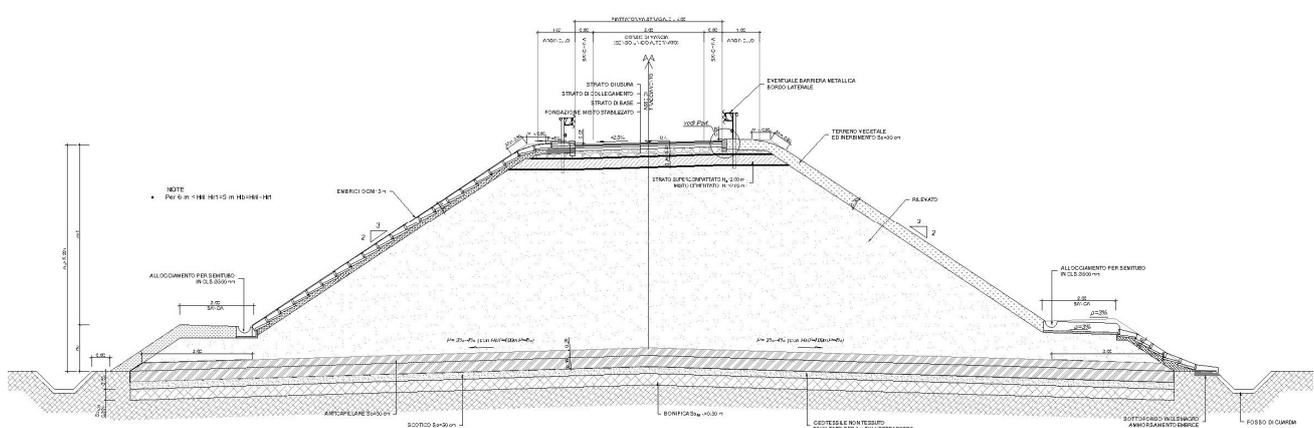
sezione tipo strada 4m in rilevato  $H_{ril} > 6.00$  m
